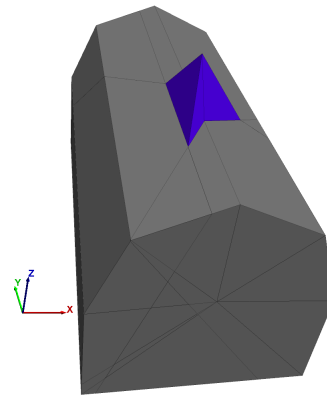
Bloc étudié au toit d’une excavation souterraine
